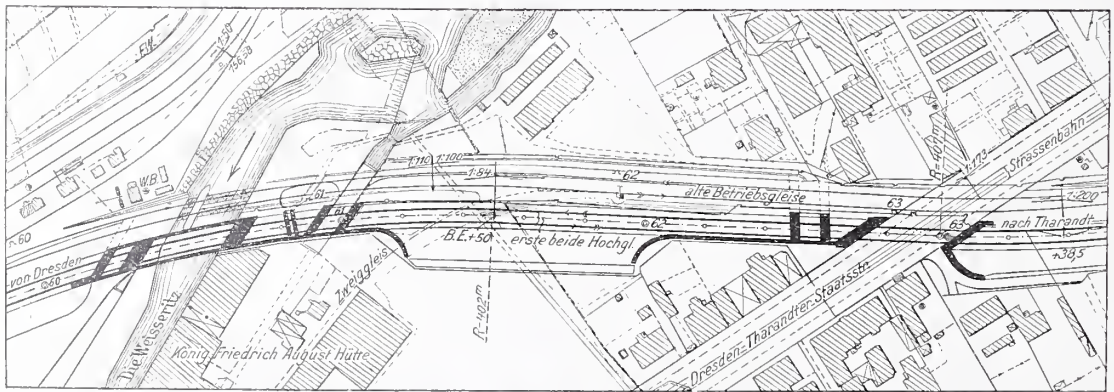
Lageplan nach Fertigstellung der ersten beiden Hochgleise.
